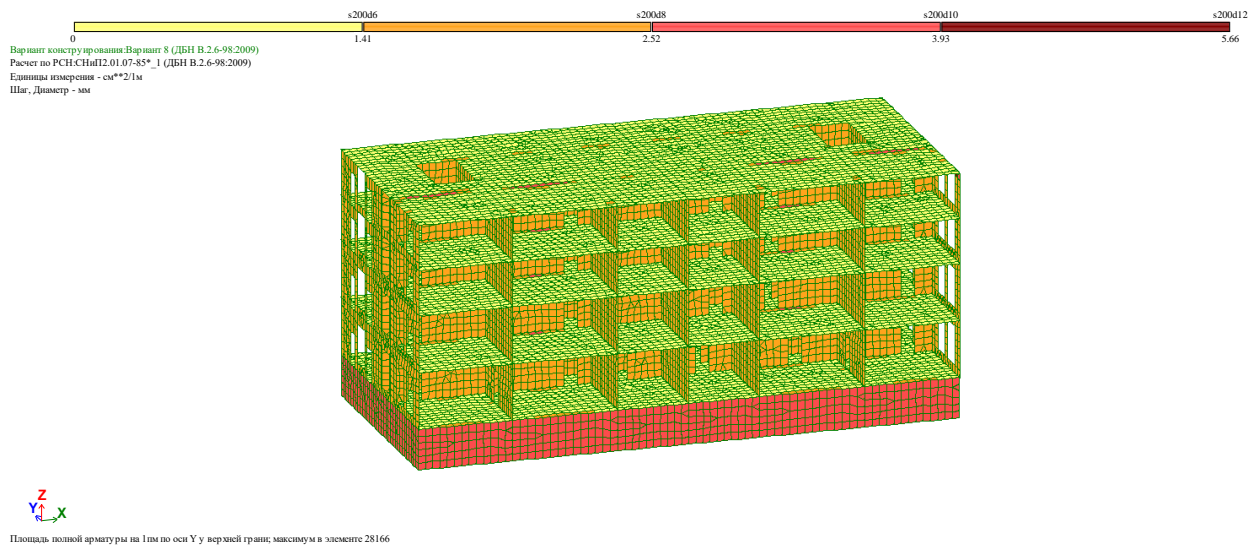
Площа повної арматури на 1м оп осі Y у верхній грані
